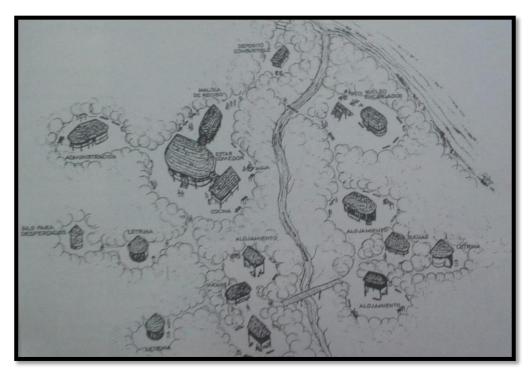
Planta general del Albergue Matsiguenka Fuente: Revista arquitextos
